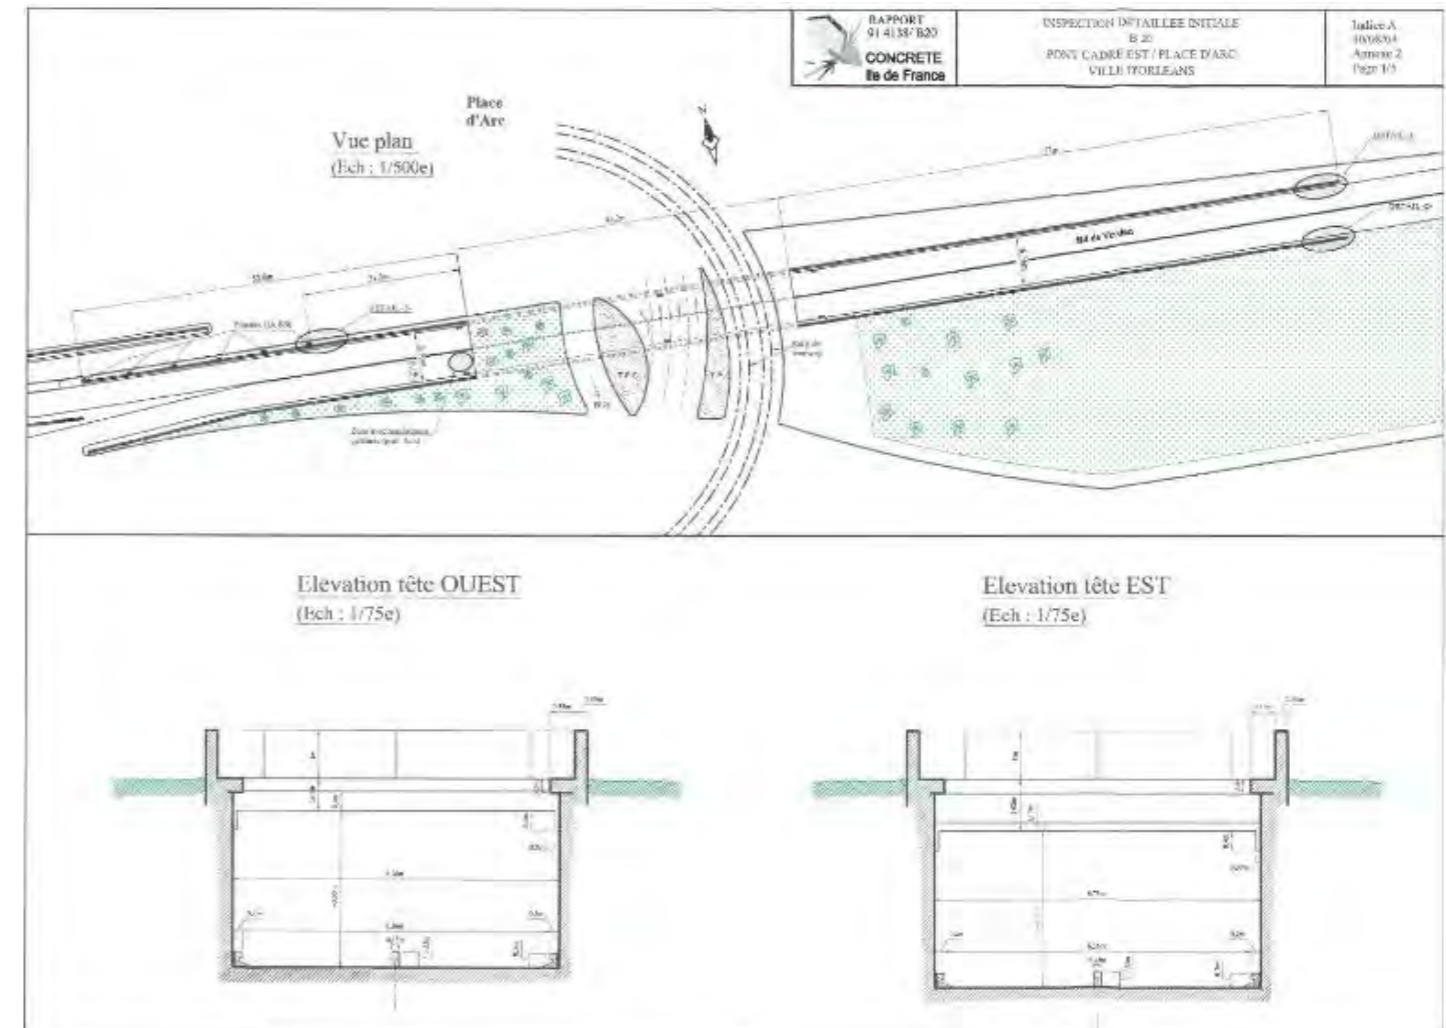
Vue en plan et élévation de principe de la trémie Est
